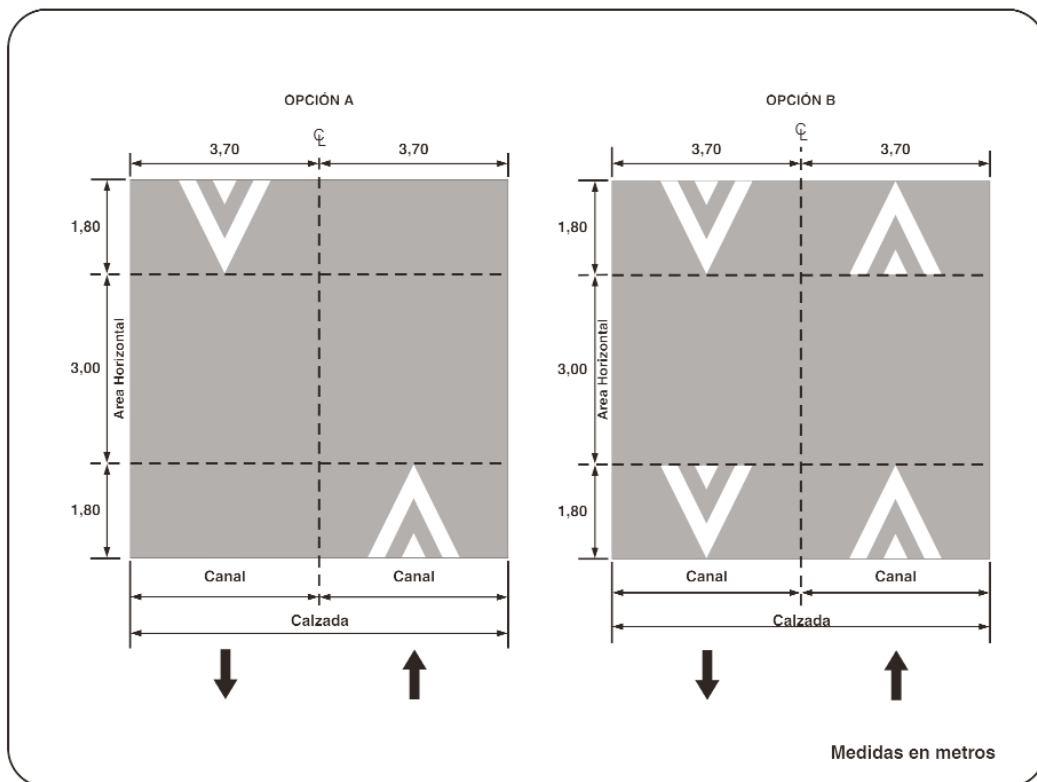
Demarcación en resaltos con perfil trapezoidal
